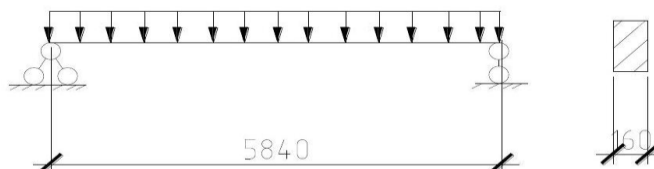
Розрахункова схема плити перекриття П1
